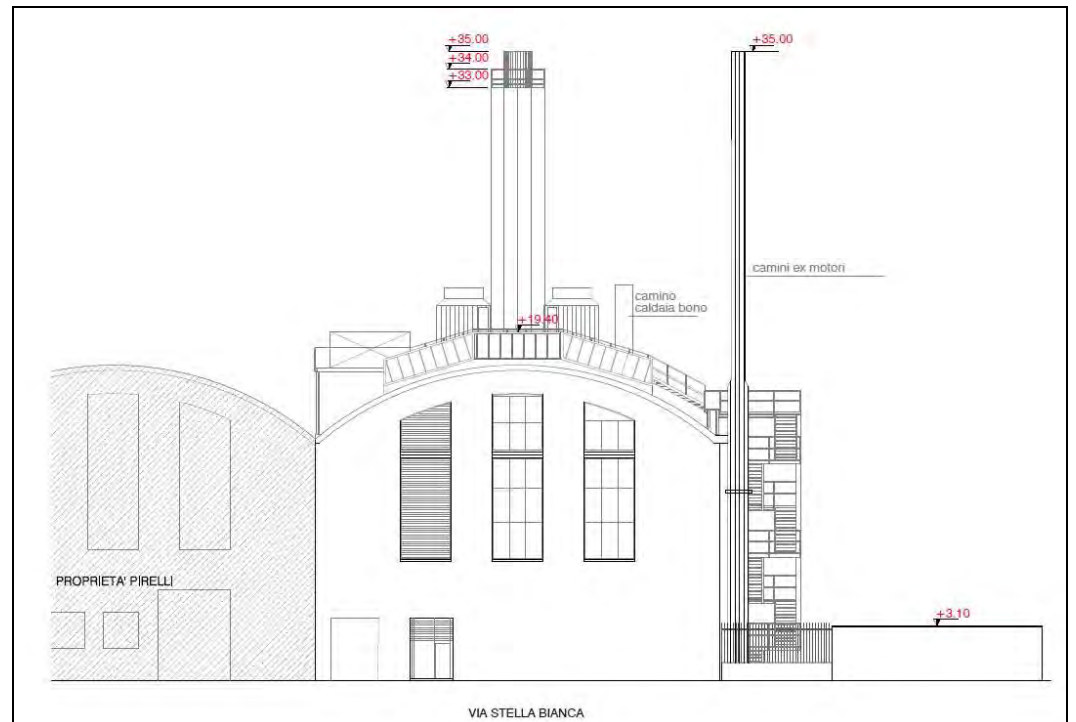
Estratto tav 01 – Prospetto sud (stato di fatto)
